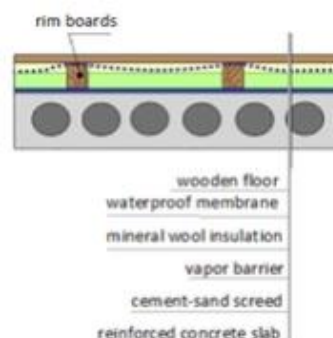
Схема накладання теплоізоляції на перекриття
